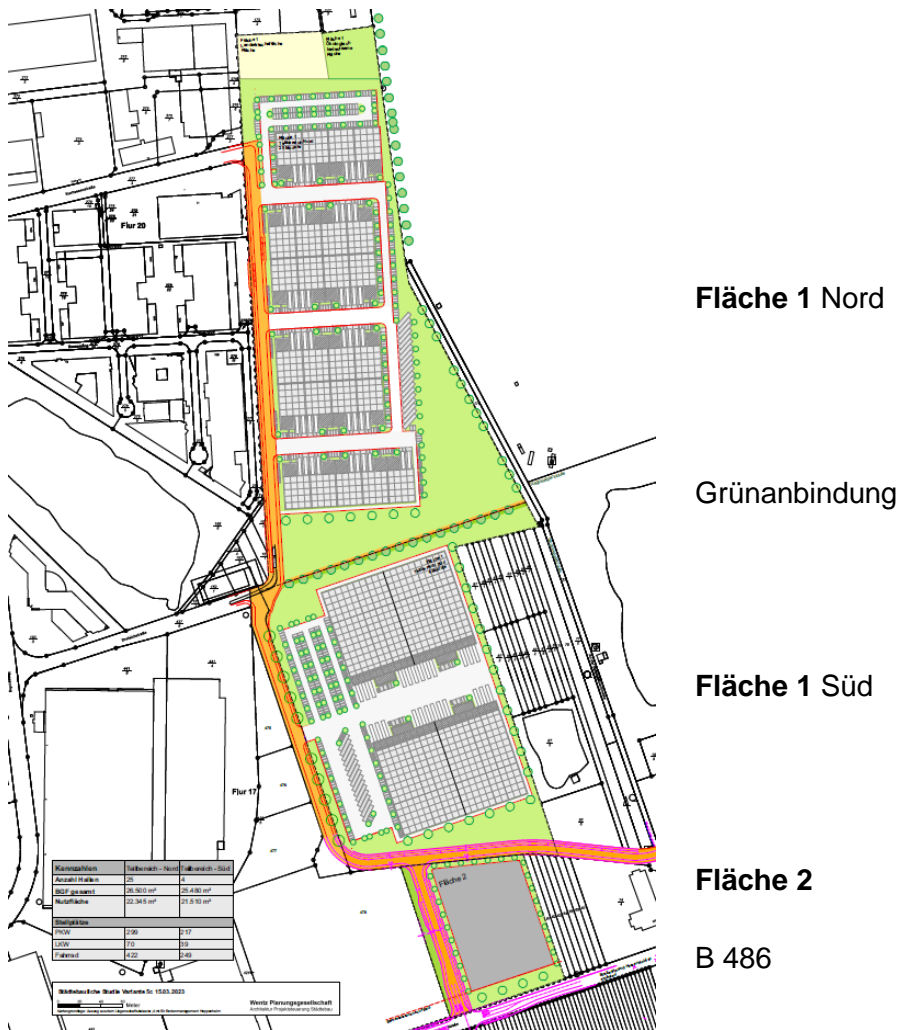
Lageplan, Planentwurf des Gewerbegebiets (Halleninnenstruktur exemplarisch)
